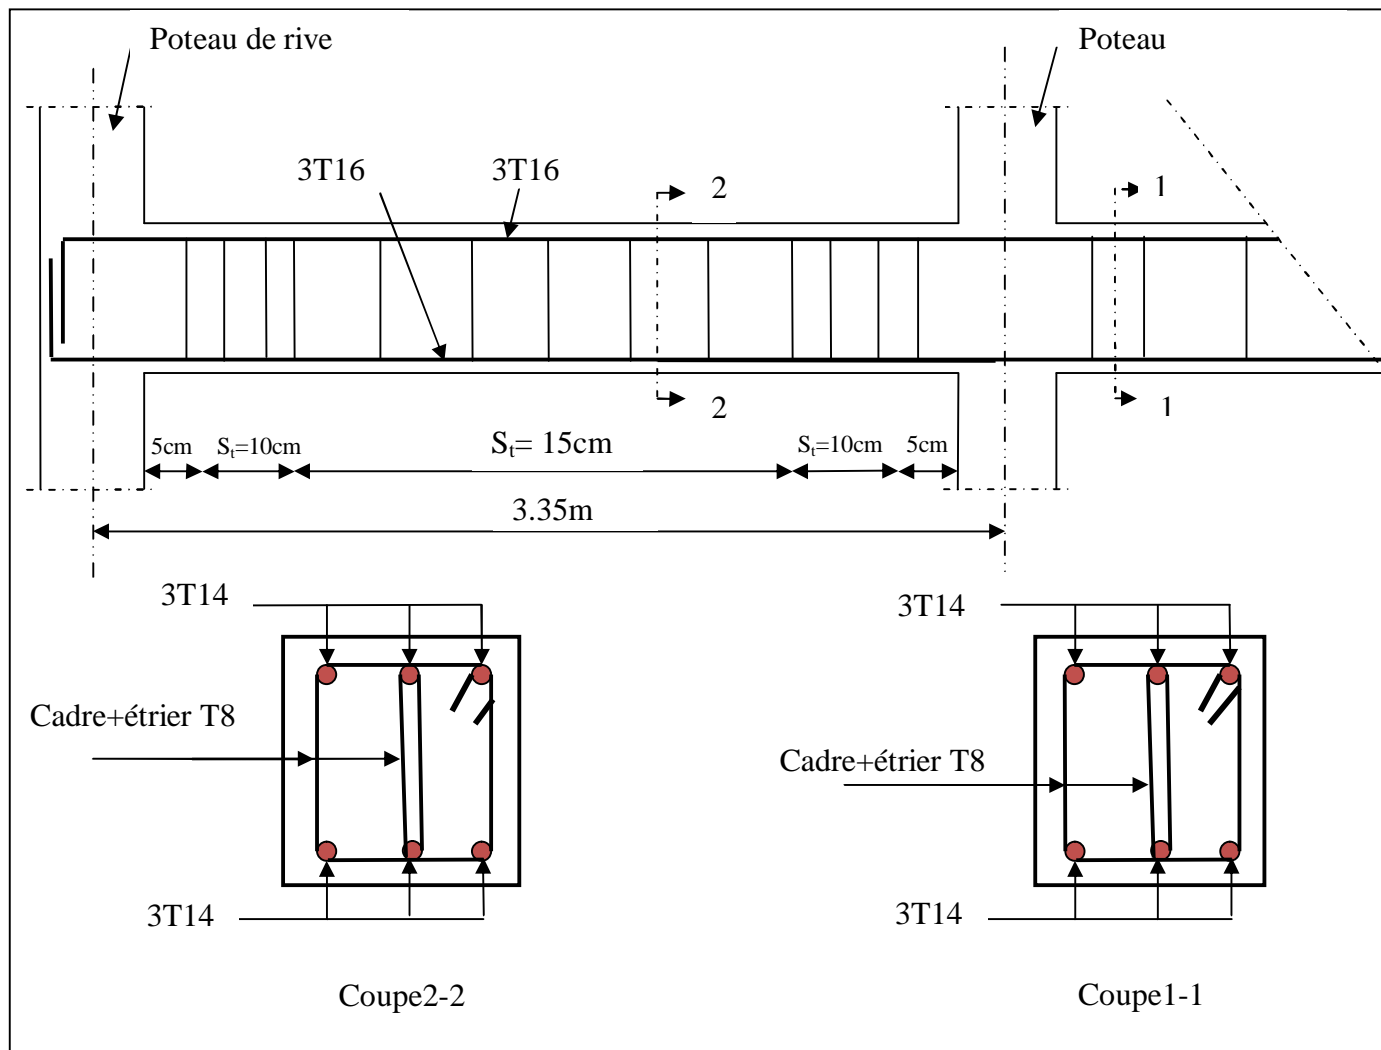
Schéma de ferrailage des poutres principales (terrasse inaccessible)
